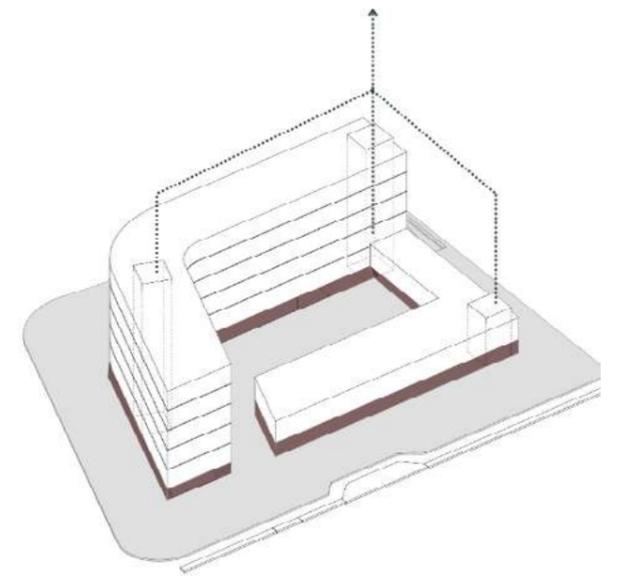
Esquema planta modelo y circulación vertical Fuente: Autoría Propia
